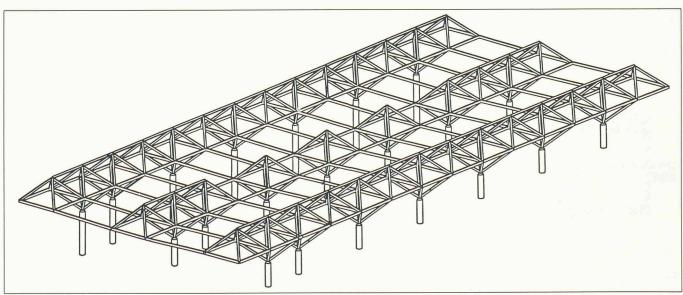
Structure de la construction métallique recouvrant le hall de la gare.
